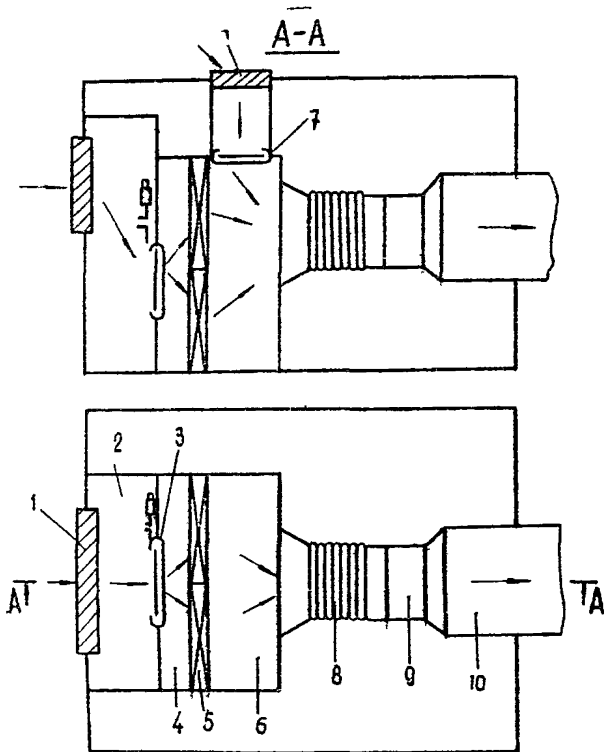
Схема вентиляторно-воздуонагревательной установки: 1-жалюзные решетки; 2-камера воздухообор-
